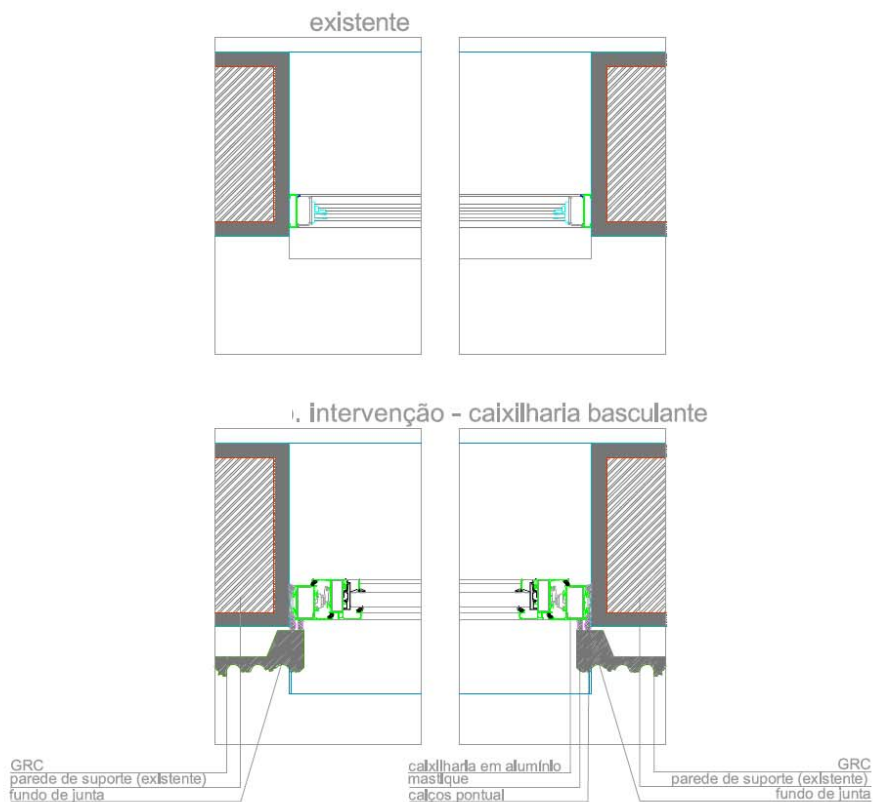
Novo caixilho basculante da caixa de escadas. Pormenor construtivo horizontal (escala 1/10).
